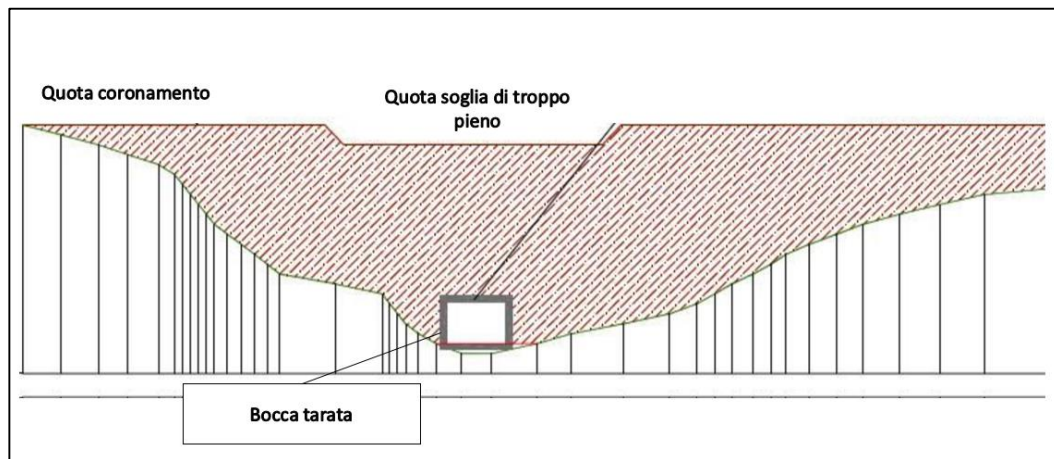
Collegamento fra sistema di drenaggio/laminazione e CIR – schema esemplificativo tipo 2 (vista in sezione)
